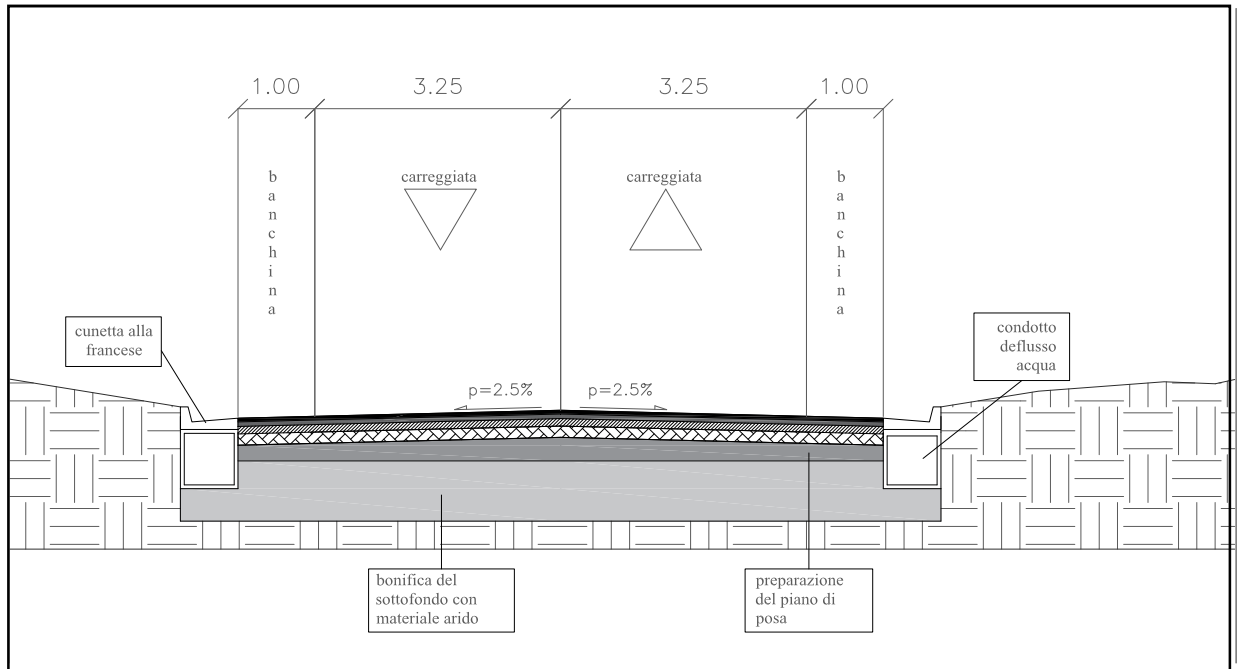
sezione tipo C1 via Ponte Monsummano (scala 1:100)
